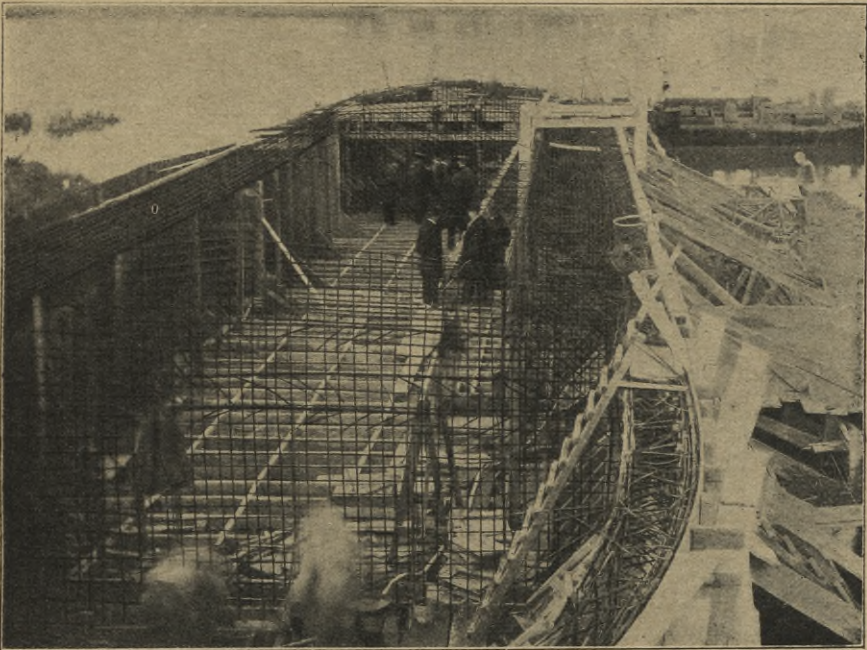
Kohlenschiff in Eisenbeton von 37,30 m Länge.
